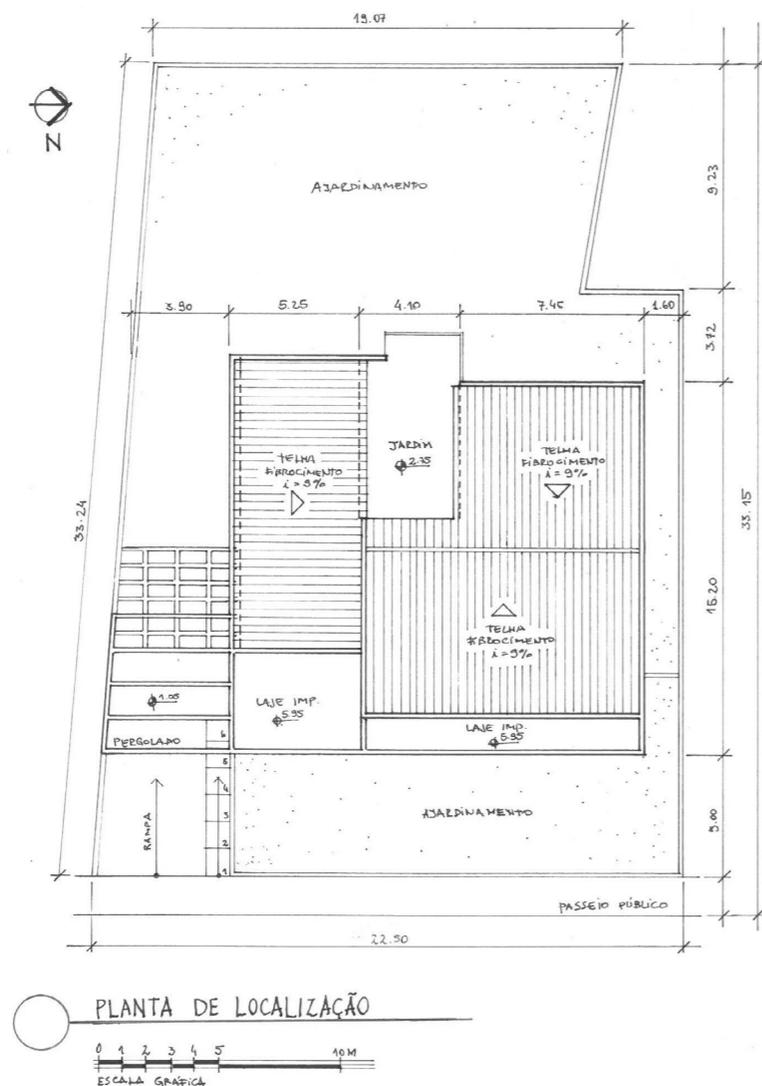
Planta de Localização e Cobertura da Casa Salles.
